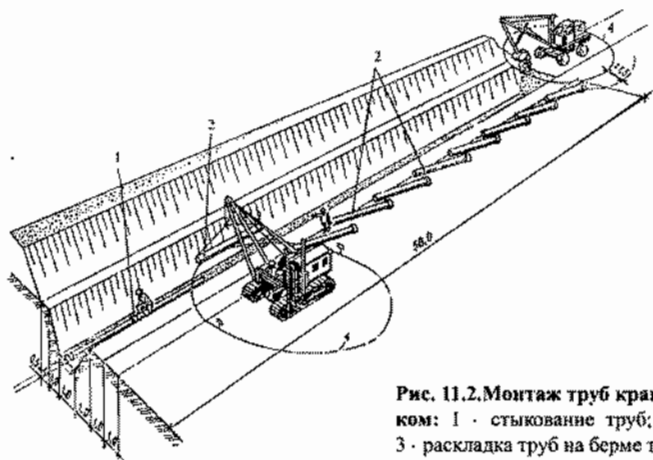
Монтаж труб краном-трубоукладчиком: 1 - стыкование труб; 2 - укладка труб; 3 - раскладка труб на берме траншеи; 4 - рабочая зона экскаватора
